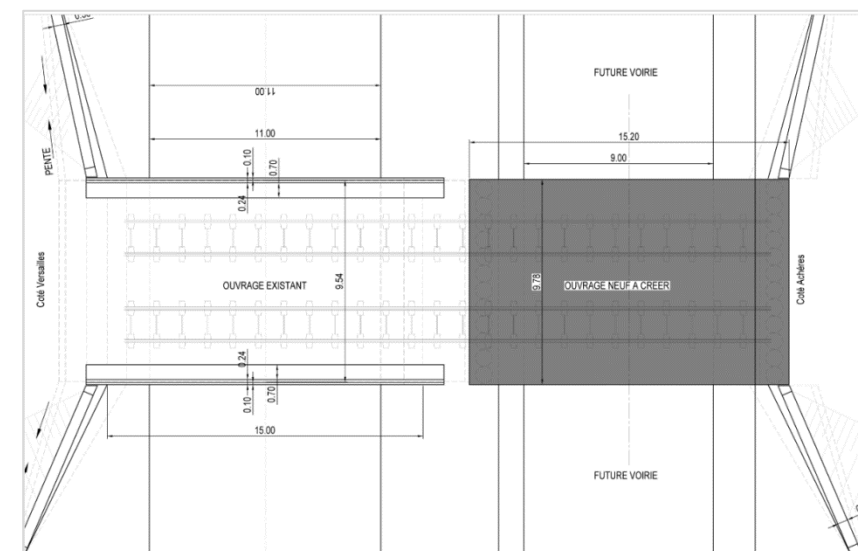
Modification de l'ouvrage sous la RD 190 (vue en plan de l'ouvrage existant à gauche et de l'ouvrage en projet à droite)
